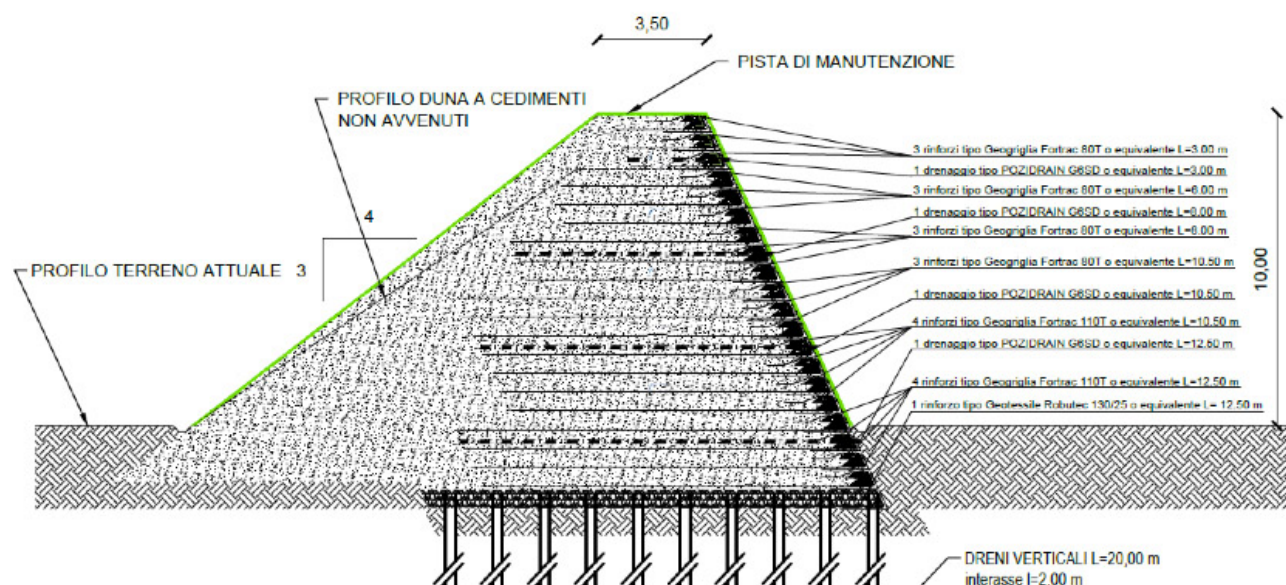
Sezione tipo con doppio fronte in terra rinforzata - Sezione tipo B.
